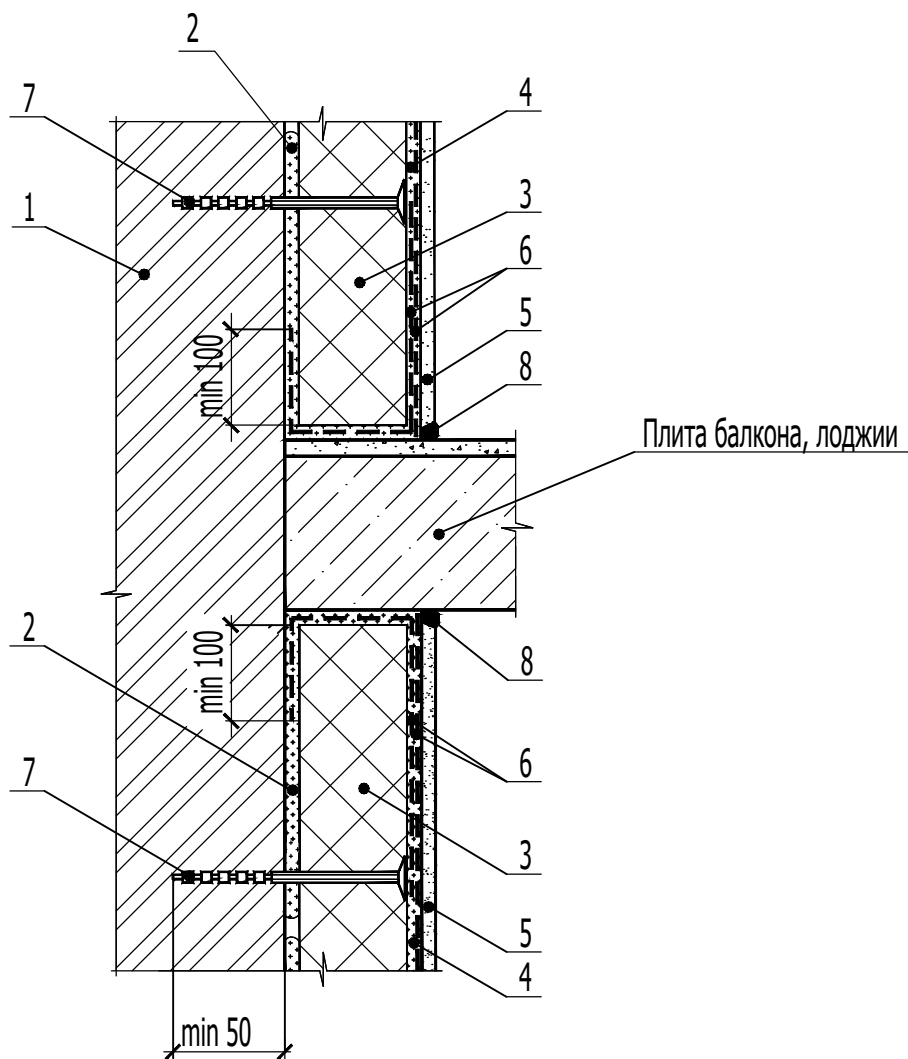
Узел примыкания края утепления к не утепляемой части стены здания
